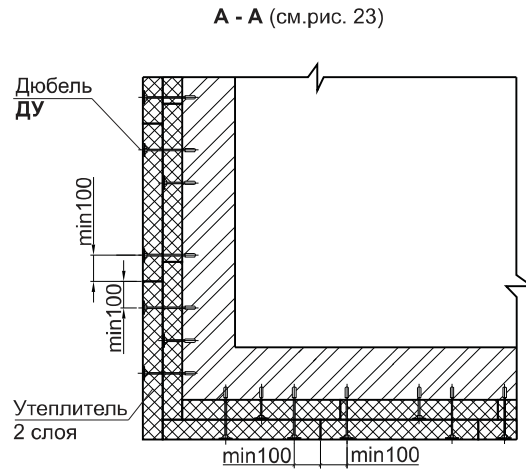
Схема крепления утеплителя на углу здания (разрез А - А).
